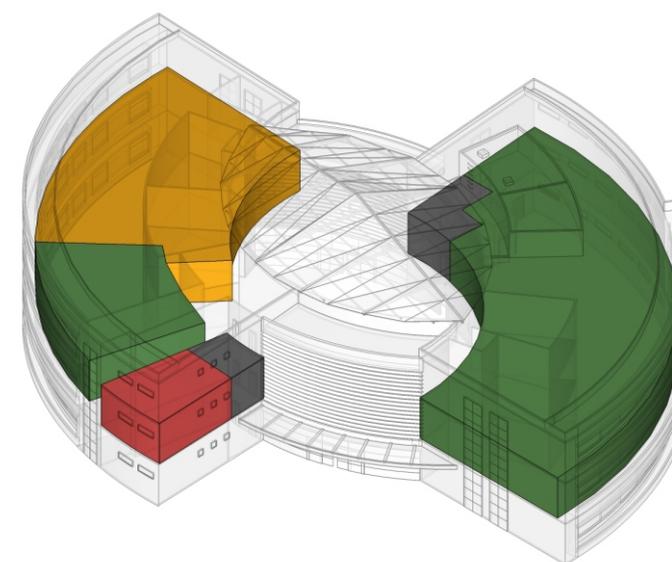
ZONEAMENTO PAVIMENTO TÉRRO.
